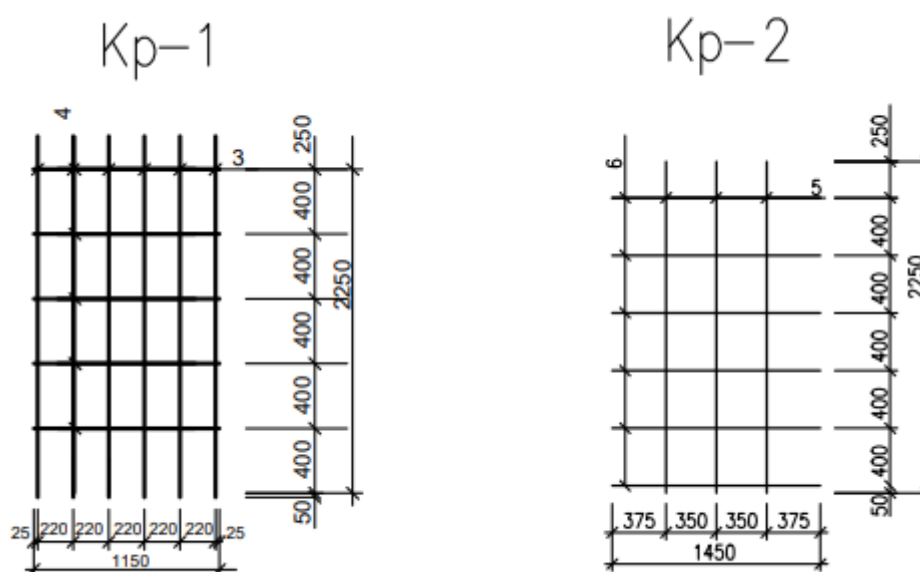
Арматурные каркасы Кр-1 и Кр-2
